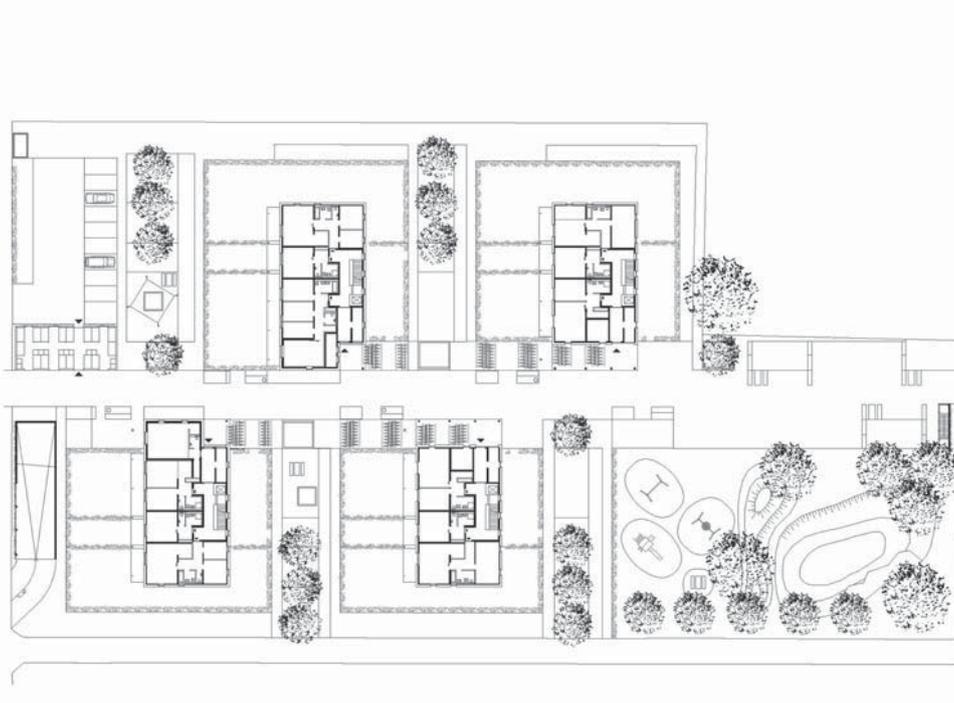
Lageplan Wohnanlage Hummelkaserne
